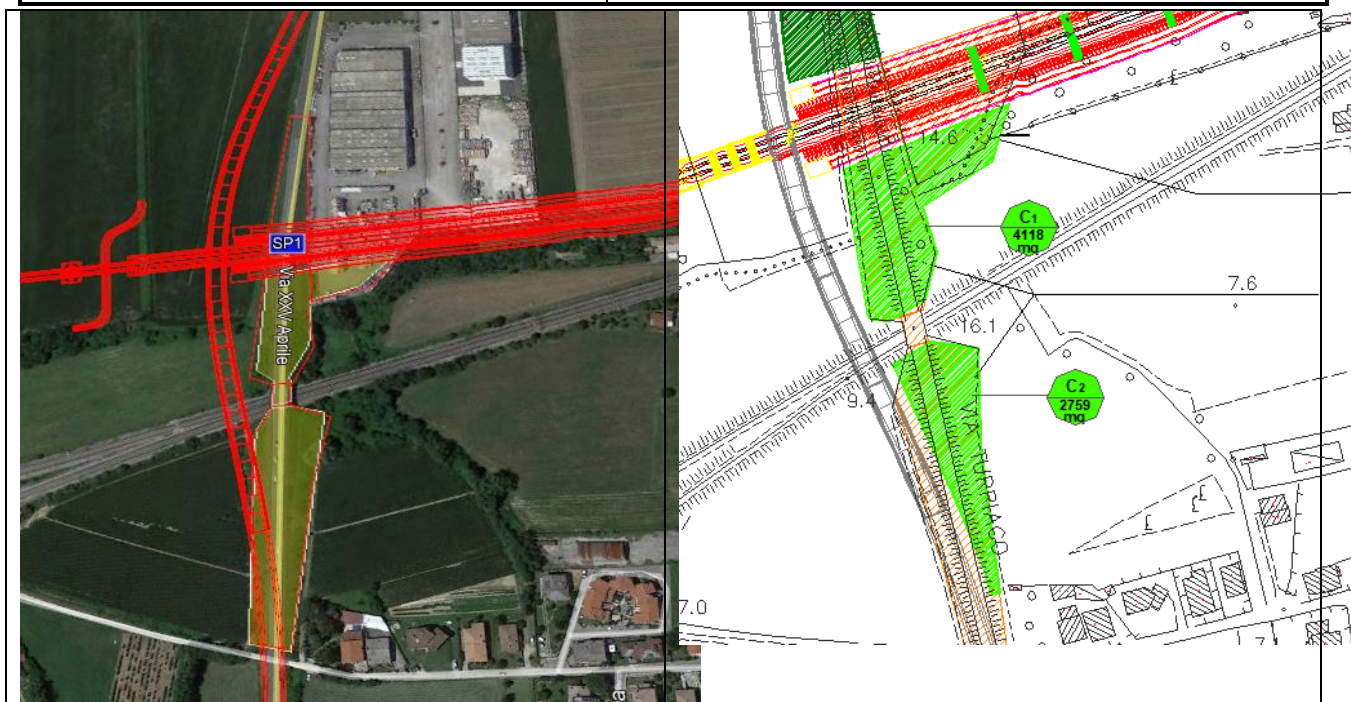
A sinistra: Localizzazione su ortofoto dei tratti in dismissione (area gialla). A destra: Stralcio planimetrico delle aree a verde Tipologico C sul tracciato si progetto Variante Isonzo
